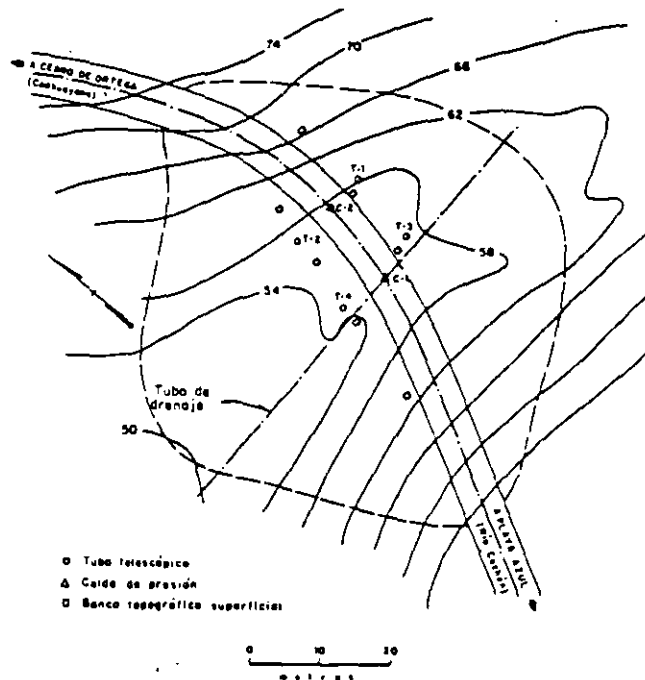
Planta de localización de la instrumentación dispuesta en el pedraplén "La Plazuela".
